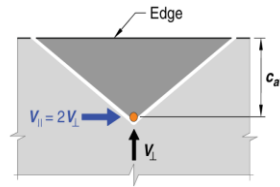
Cortante paralelo a un borde. Tomado de *Building Code Requirements for Structural Concrete (ACI 318-19)*, por American Concrete Institute, 2019. Copyright 2019 por American Concrete Institute.
